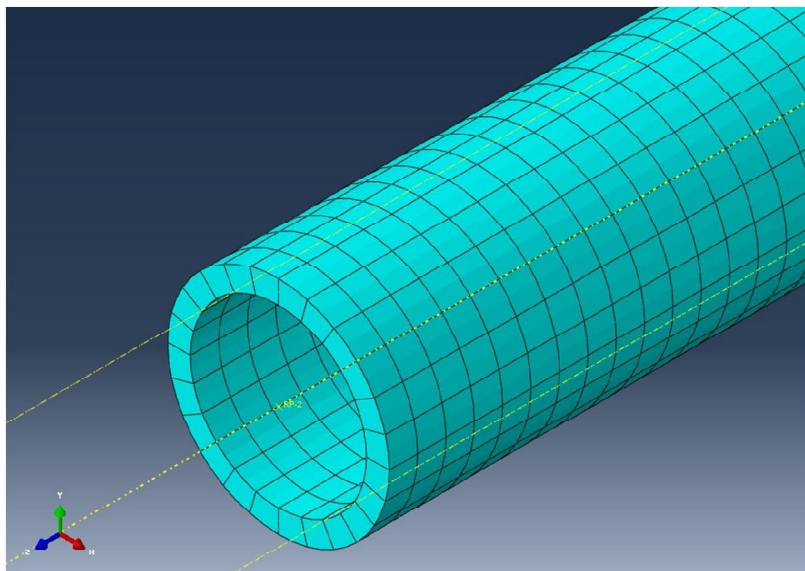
Malha do concreto do poste de seção circular vazada (vista aproximada)
